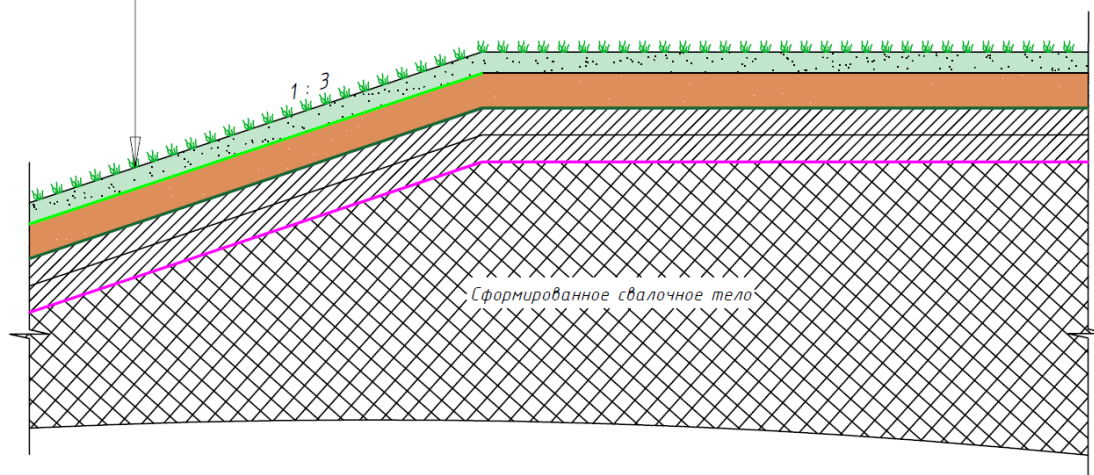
Конструкция верхнего изоляционного покрытия
